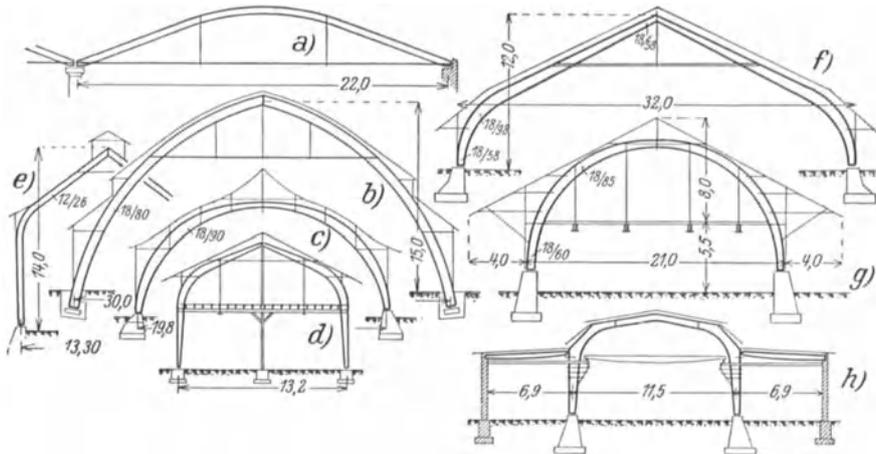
Vollwandige Hallenbinder nach Bauweise Hetzer. a) Zweigelenk-Flachbogen mit Zugband. b) Dreigelenkbogen. c) Reithalle; Dachsparren wellig gebogen, darauf eine mit Dachleinwand überspannte Holzschalung. d) Lagerschuppen mit Ziegeleindeckung und Zwischendecke für 1200 kg/m² Nutzlast. e) Hochstieliger, f) flacher Dreigelenkbogen. g) Rahmen mit Nutzdecke. h) Maschinenhalle.
